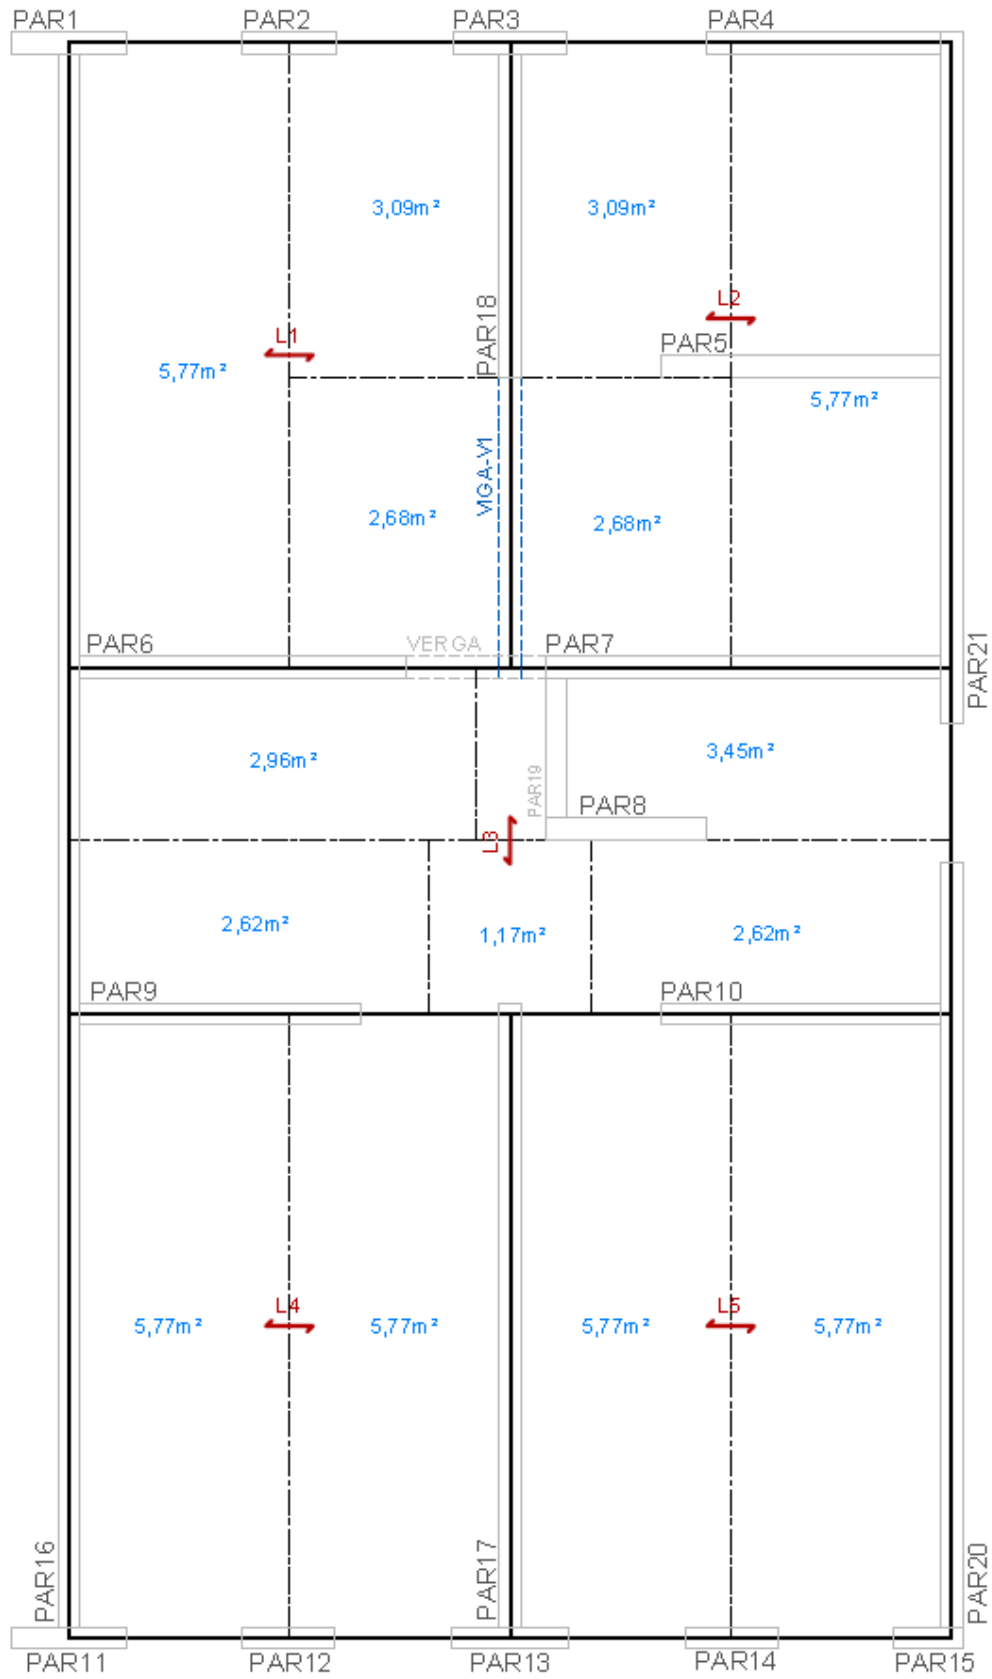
5 Especificação da região de apoio das lajes, Pavimento Superior.
